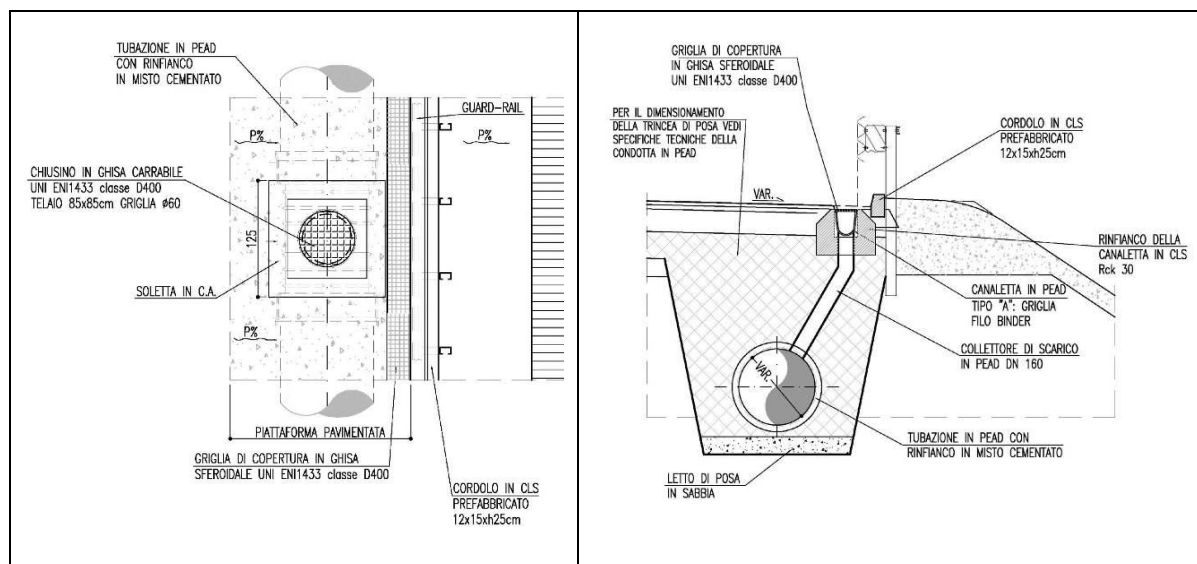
Pianta tipo pozzetto di ispezione e sezione tipo con scarico nella sezione longitudinale nel caso di rilevato
